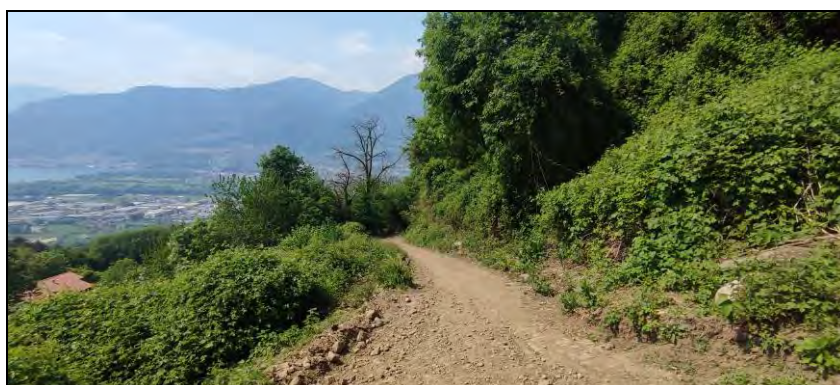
inquadramento delle aree di intervento, tratto a monte del ponte
